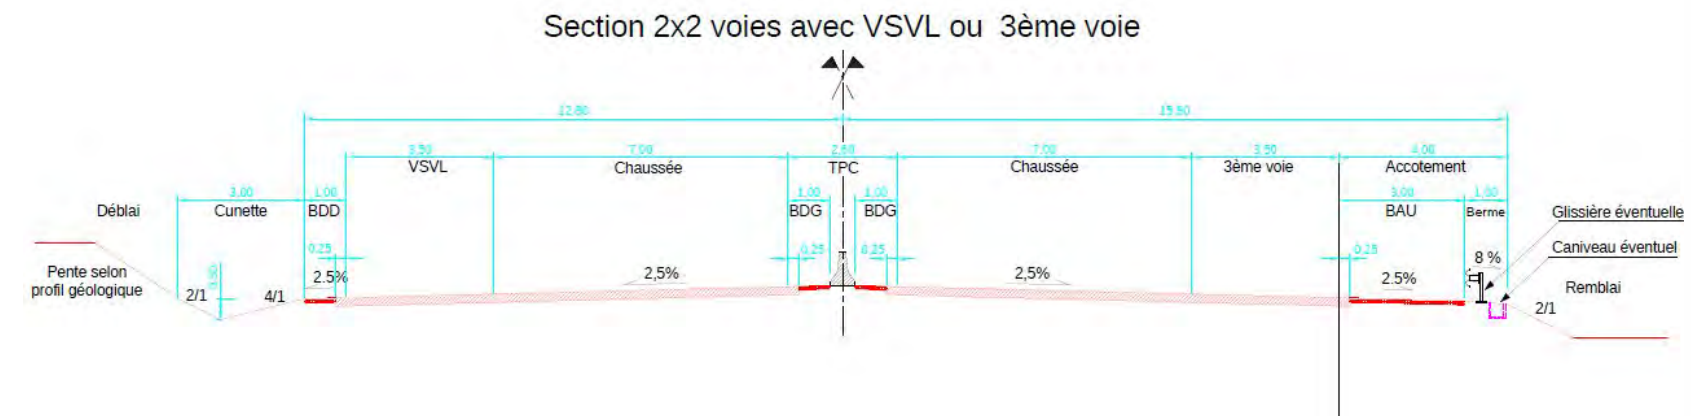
PROFIL EN TRAVERS TYPE DANS LE CAS D'UNE VSVL OU D'UNE 3EME VOIE
